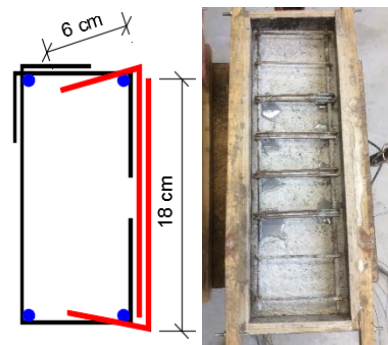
Recuperação do modelo 5. Armaduras de estribo ancoradas com chumbador químico e traspasadas pelas laterais do estribo seccionado e amarradas com arame recozido. Fonte: Autor, 2017.
